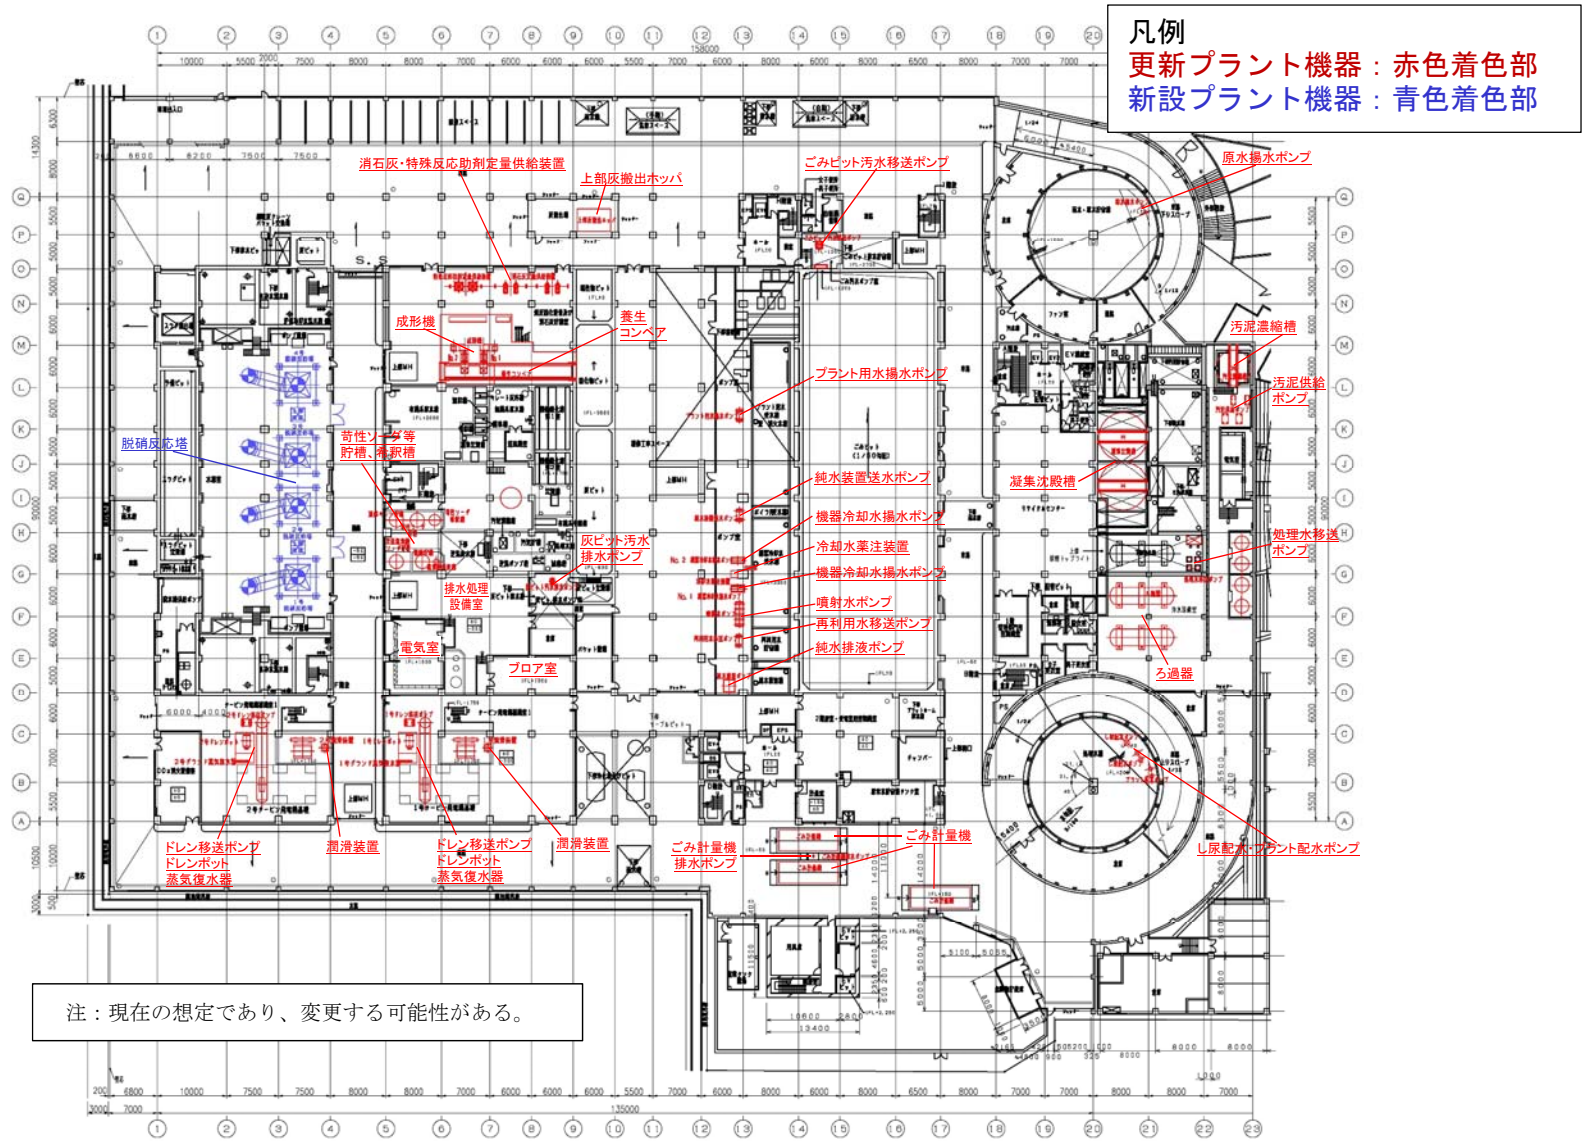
(1) 設備機器の更新箇所 (1階平面図)
